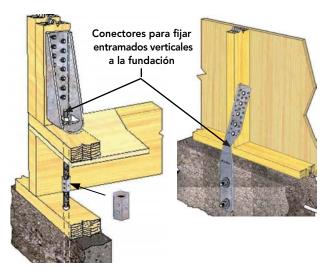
Alternativas de conectores metálicos para fijar elementos verticales como tabiques o pie derecho.
